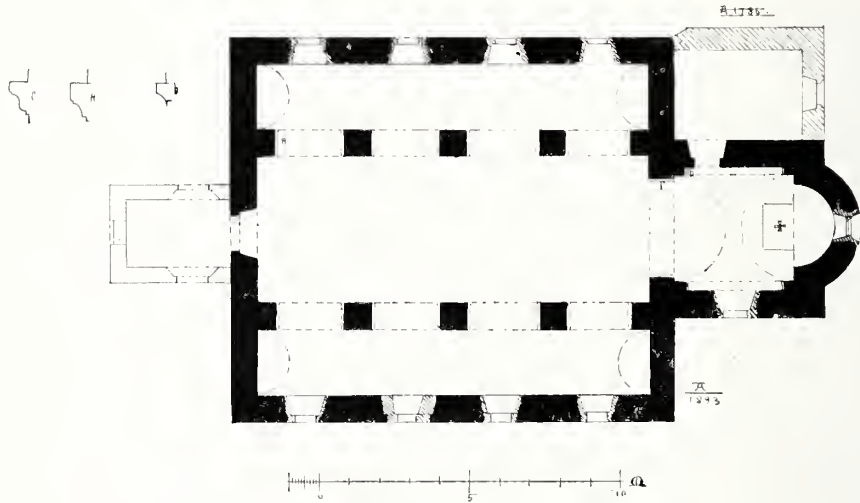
Odendorf. Katholische Pfarrkirche. Grundriss.
